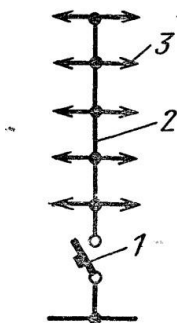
Схема разомкнутой питающей сети секции жилого дома
